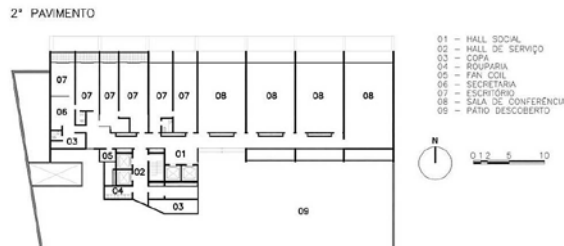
Planta 2º Pavimento. Fonte: Souza, 2015.
